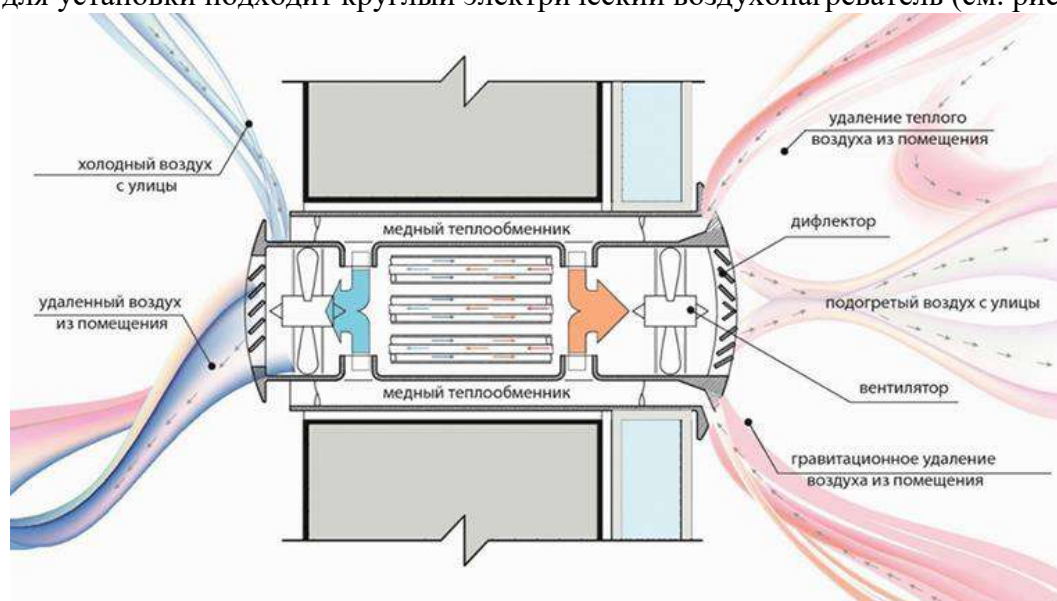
Принцип работы стандартного воздушнонагревателя.
